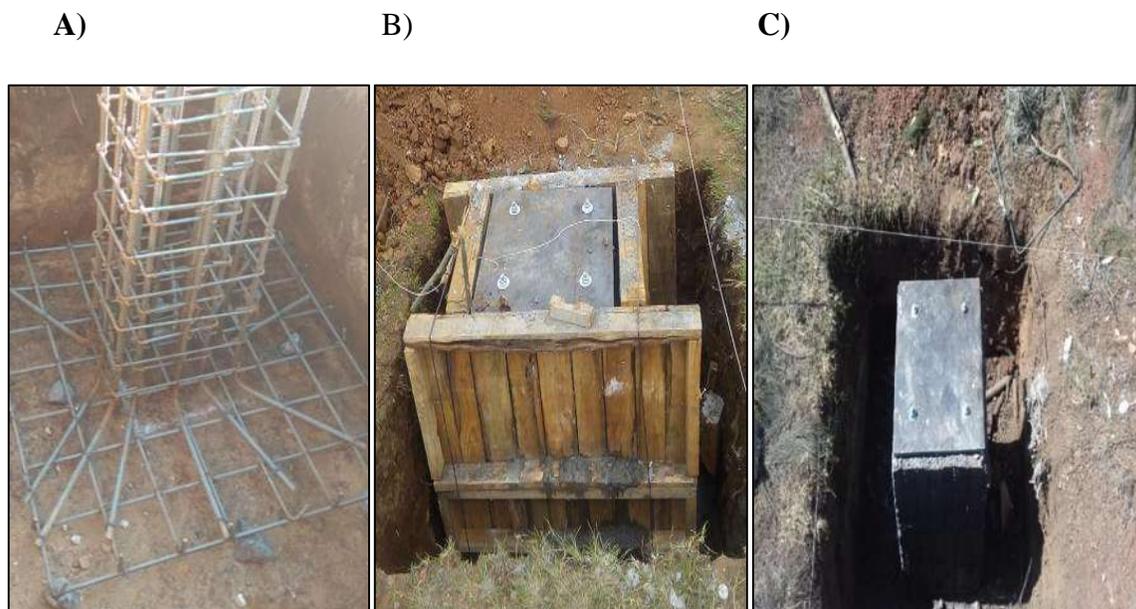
Proceso de elaboración de zapatas. A) En la primera figura se observa el acero de las varillas del número 3 y 4. B) Se observa la zapata cimbrada y colada. C) Finalmente, la zapata se encuentra cerrada.
